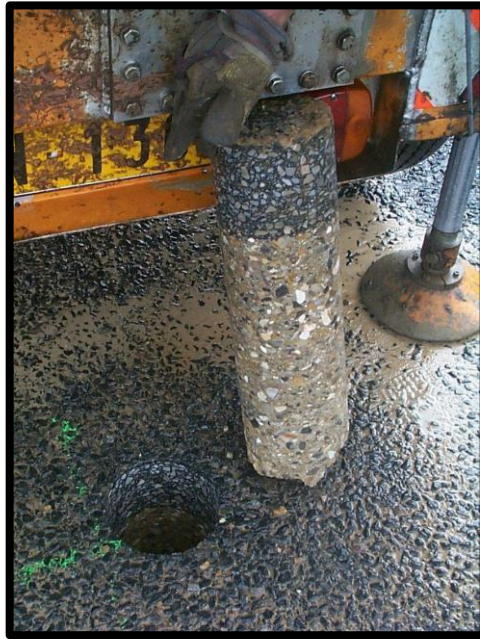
Echantillon cylindrique dans un corps de chaussée
